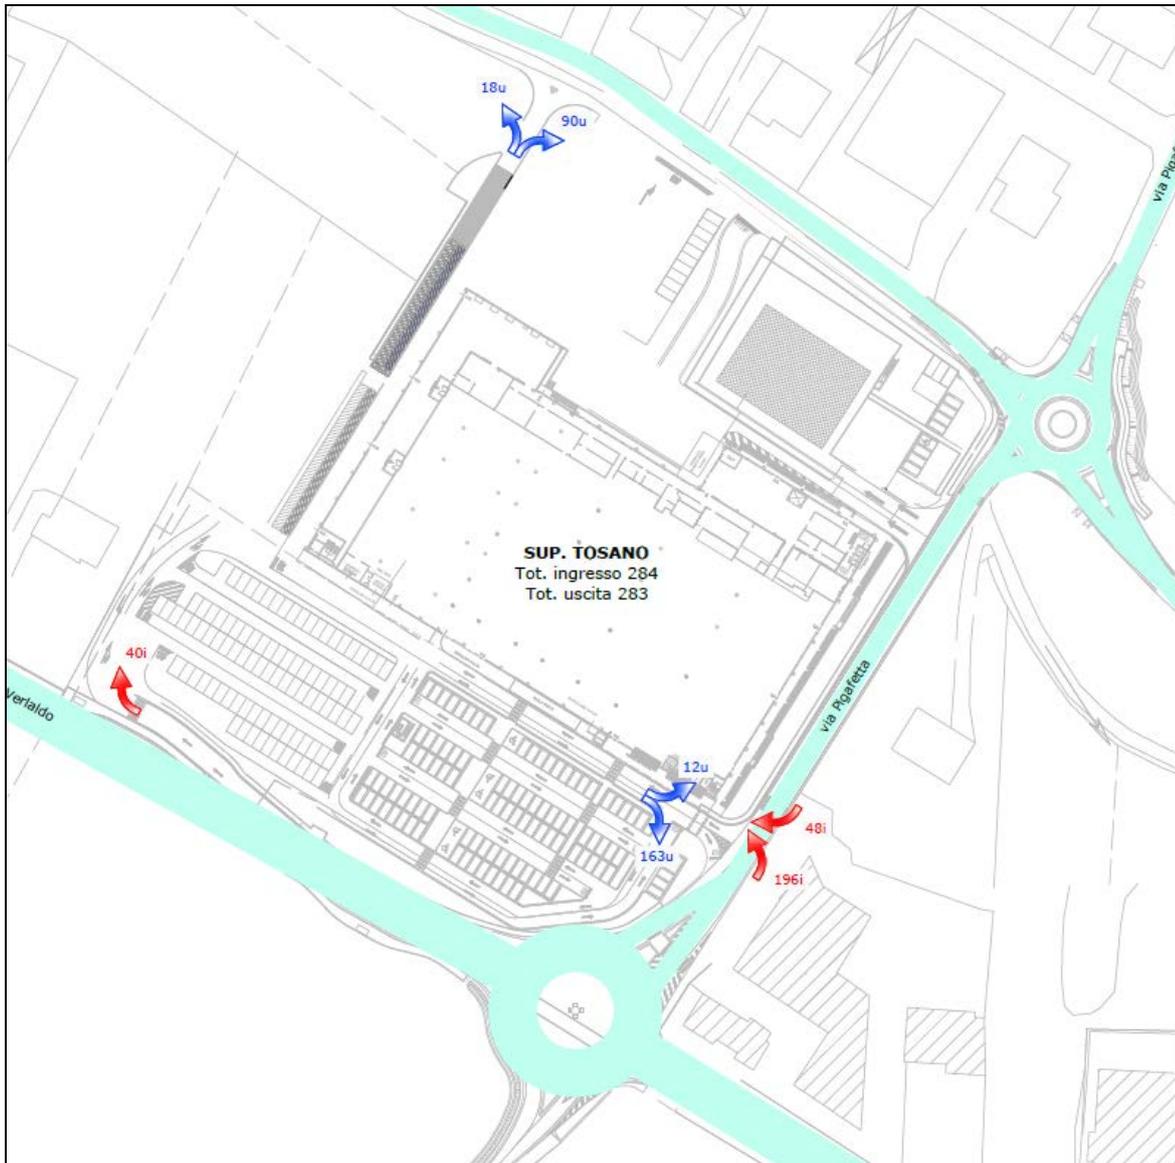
Manovre rilevate accesso struttura di vendita – sabato 16.30 – 17.30
